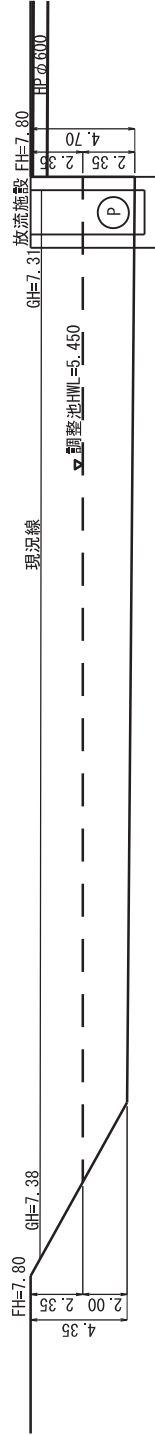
(3) 調整池計画平面・断面図 (第3調整池)
